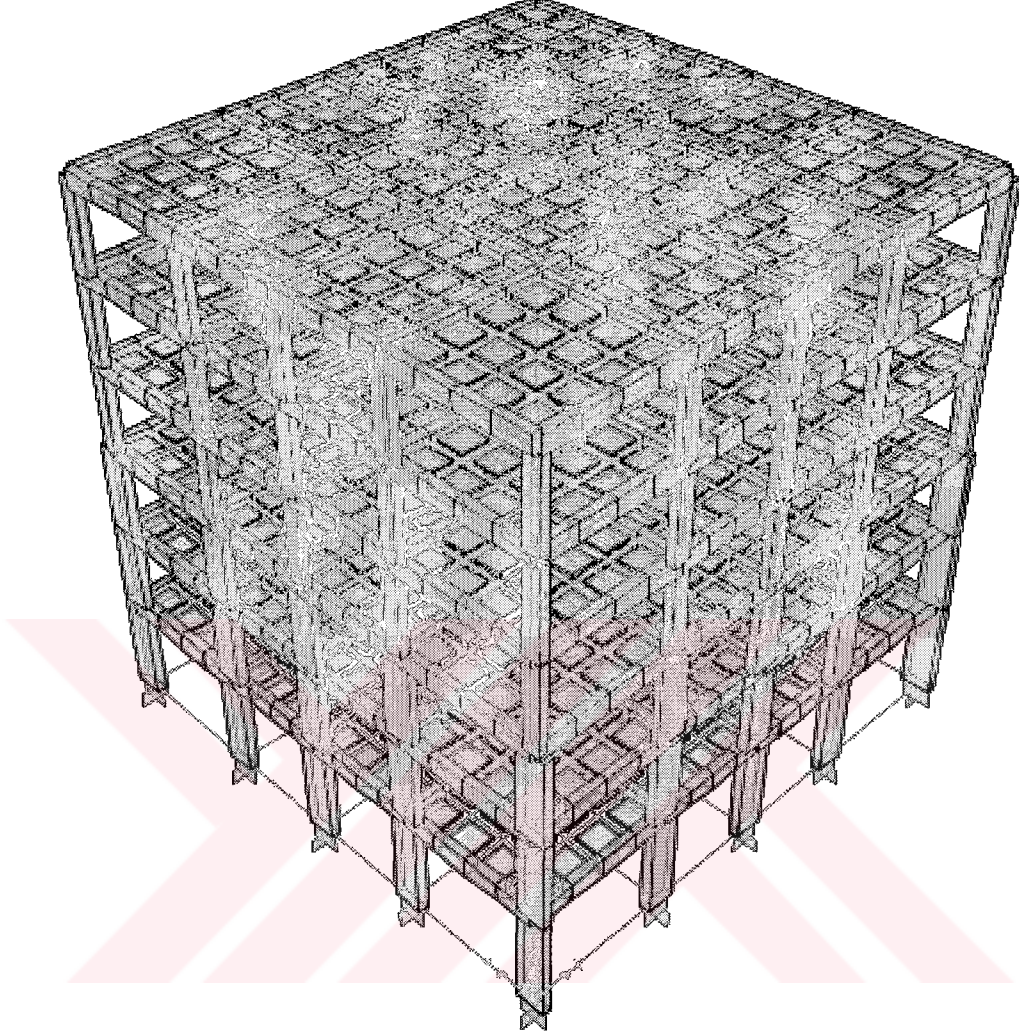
Taşıyıcı Eleman Eksenleri Paralel Olan Düzenli Yapı Planı
